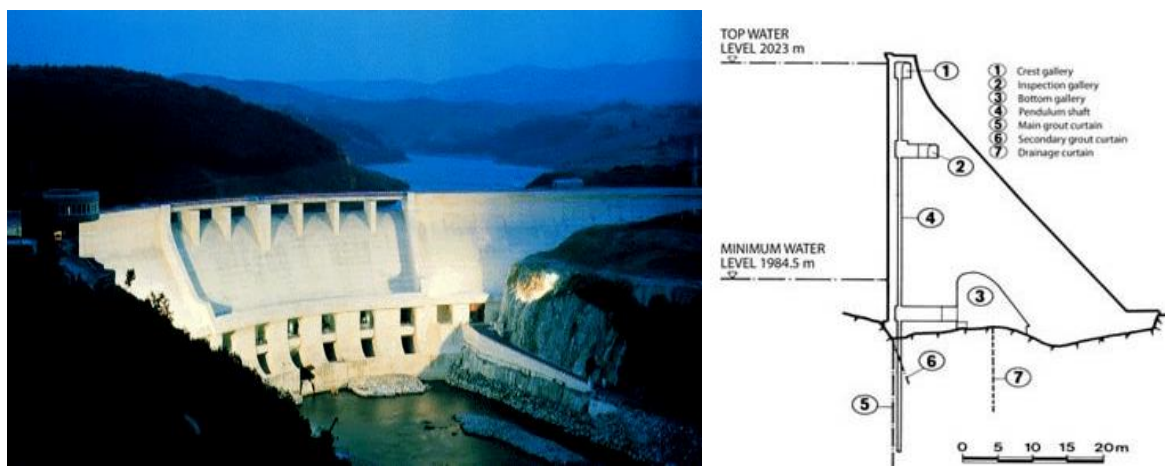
Presa de Villaverde gravedad (izquierda) y sección típica de una presa de gravedad (derecha)
